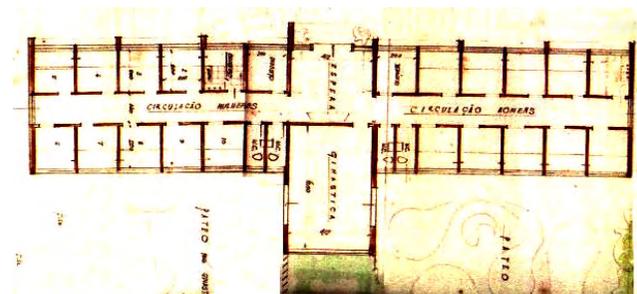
Planta baixa e esquema da Casa de Banhos. Fonte: Projeto cedido pelo Eng. Romeu Paulo da Costa.
